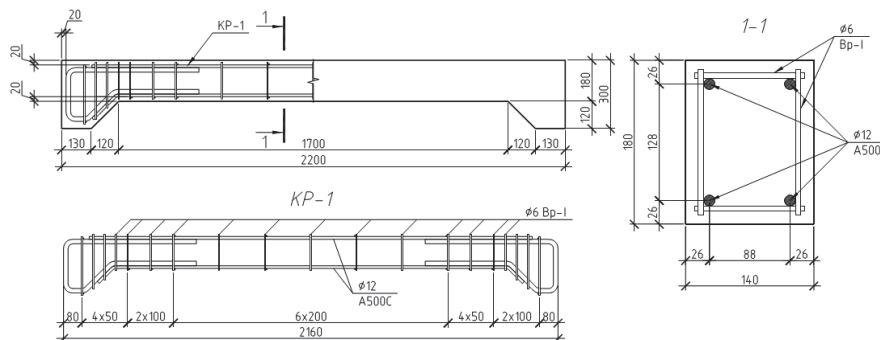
Опалубне креслення колон та конструкція каркасу зразків.
